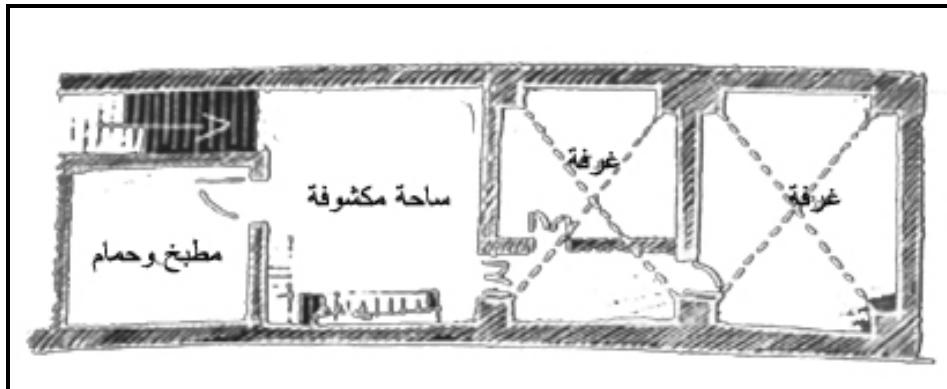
مخطط الطابق الأرضي لبيت ذو ساحة مكشوفة
